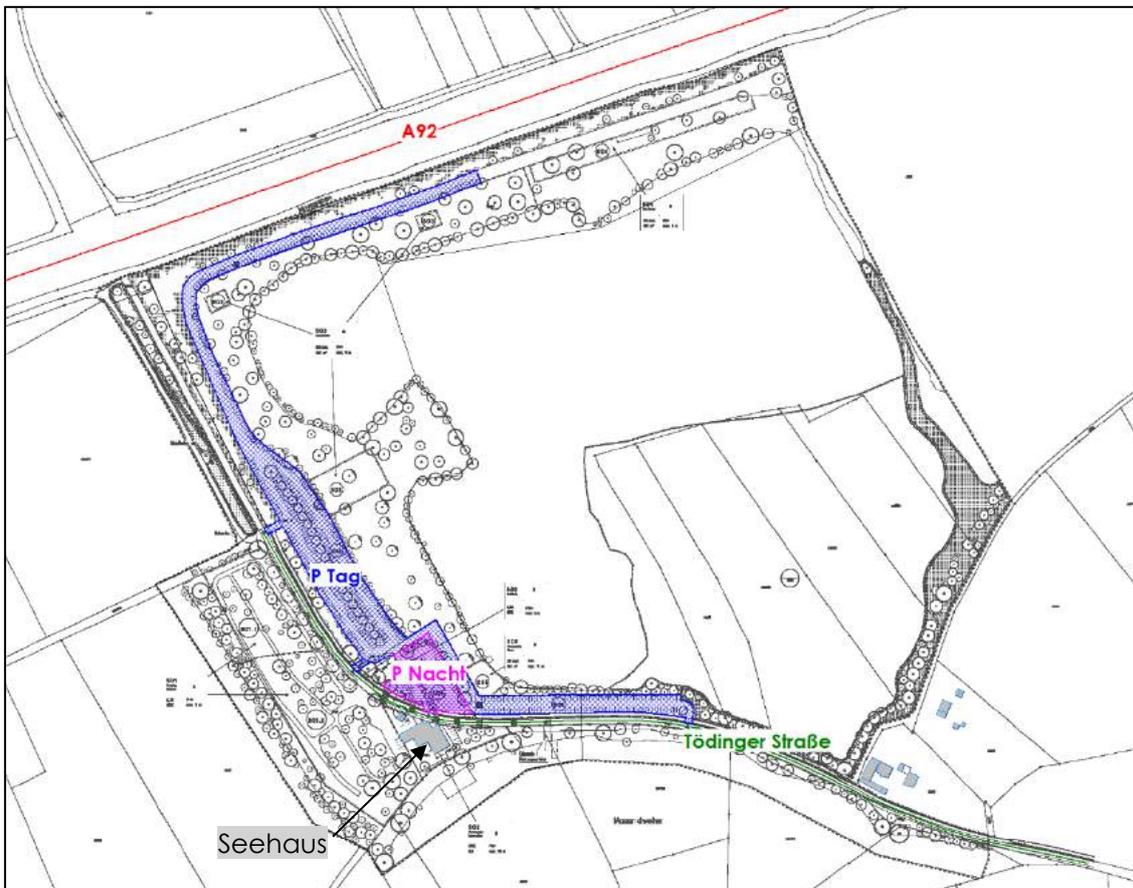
Lageplan mit Darstellung der relevanten Schallquellen
